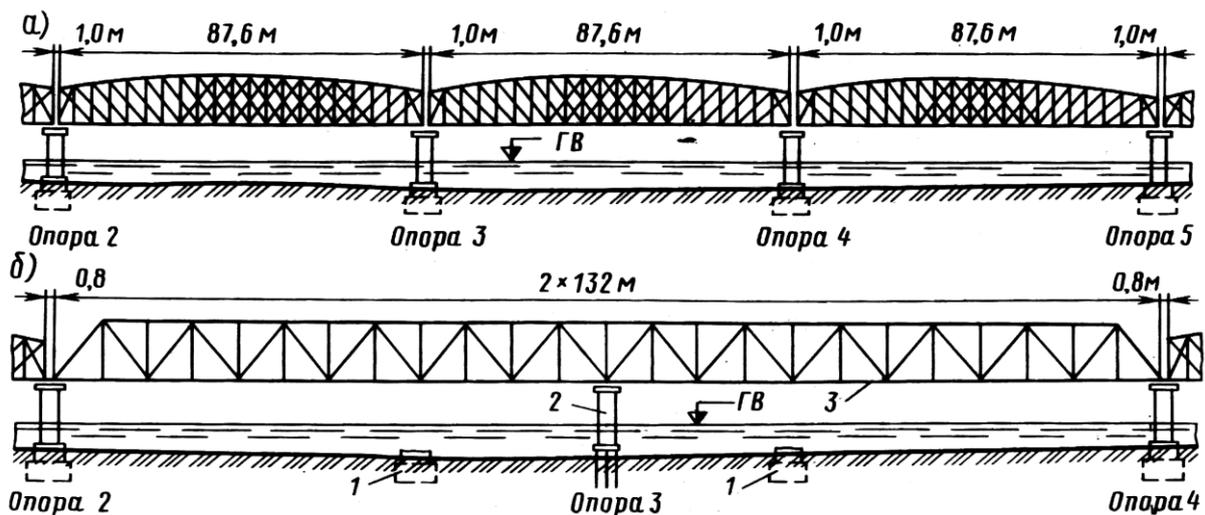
Реконструкция моста с увеличением судоходных пролетов: а – мост до реконструкции; б – мост после реконструкции; 1 – фундаменты разобранных опор; 2 – новая опора
